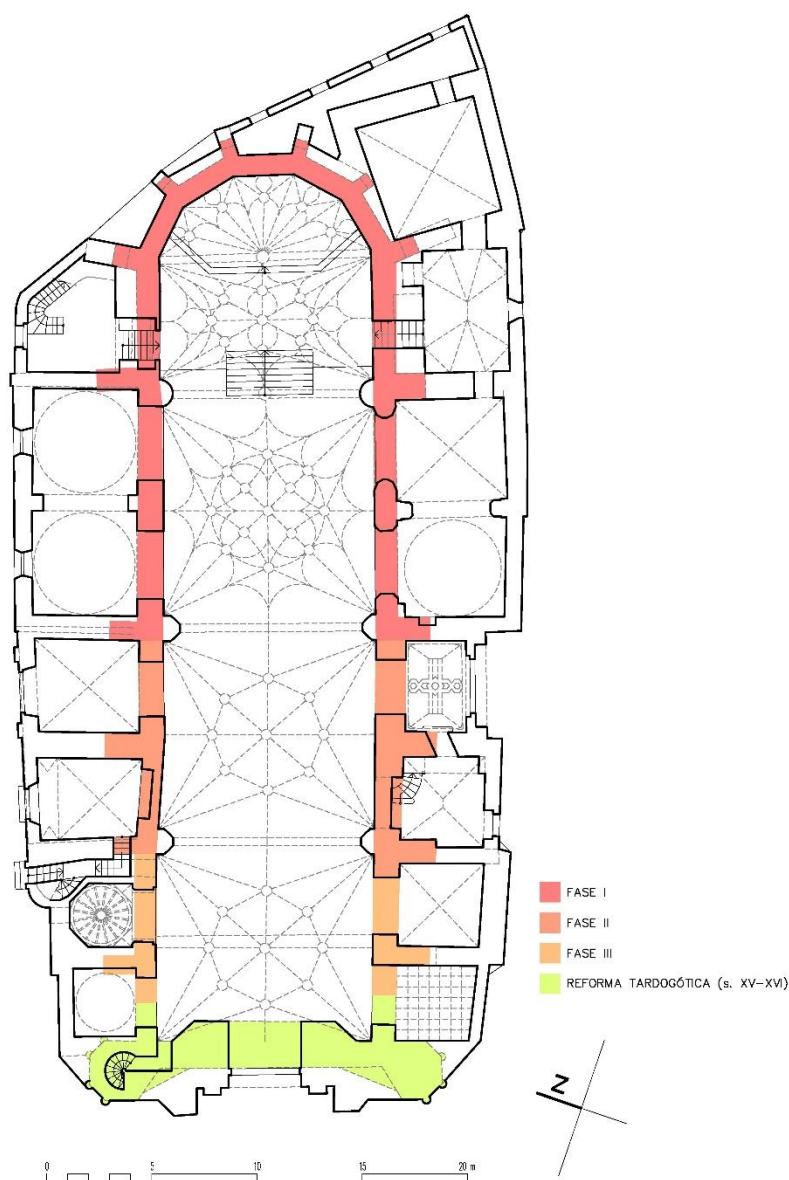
Fases constructivas. Planta. San Marcos. Jerez.
